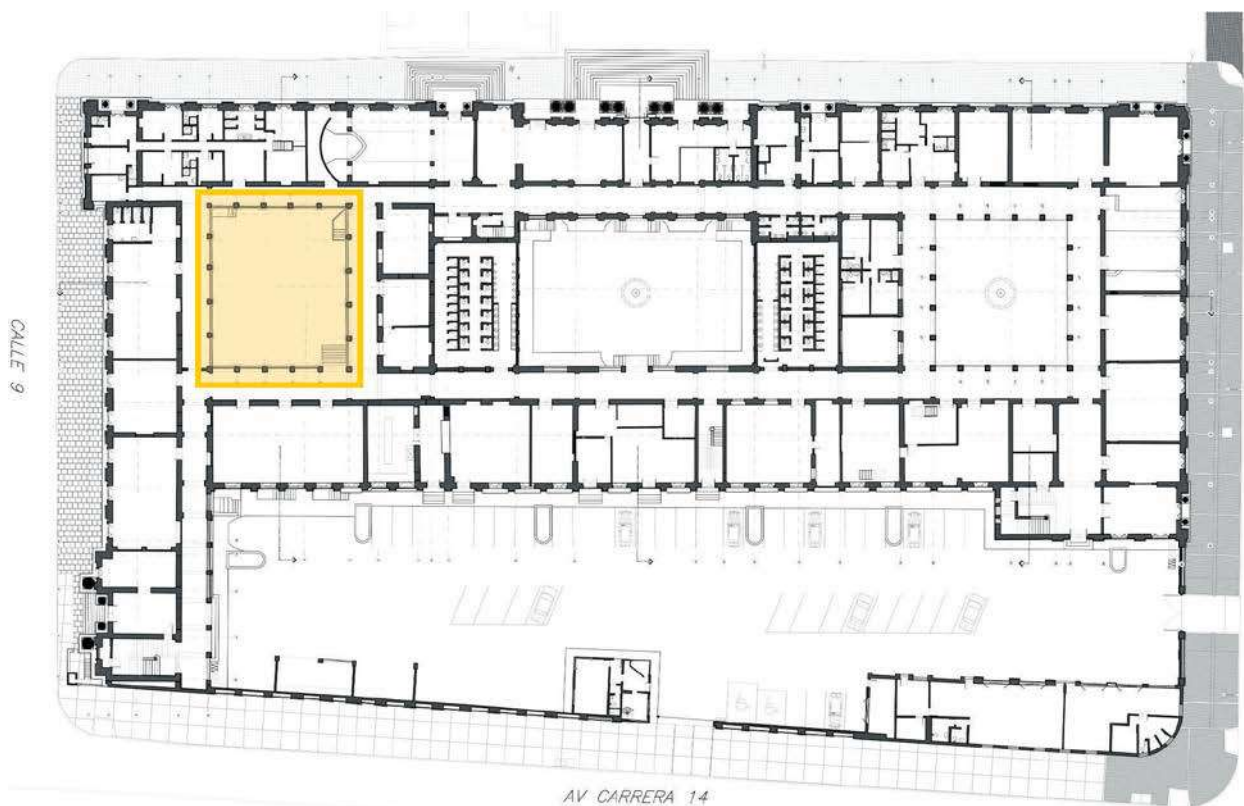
Plano Planta de primer piso con la ubicación del Patio Sur.
